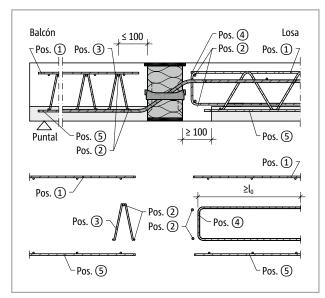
Schöck Isokorb® XT tipo Q-V5 hasta V11: Armadura in situ con viga de celosía
